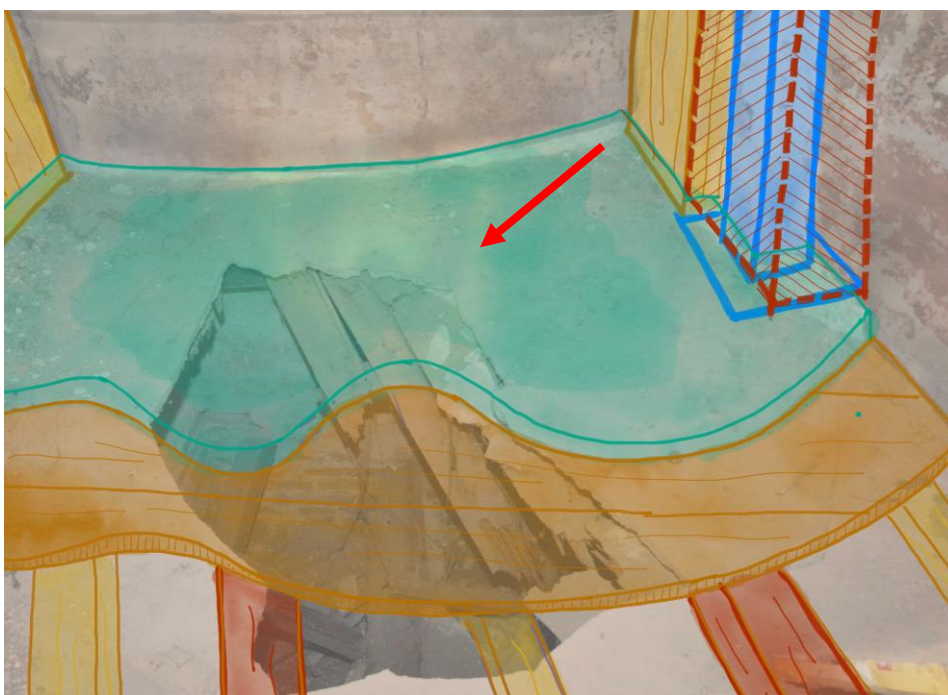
Intervento sui solai dei palchetti (vista estradosso): Raddoppio orditura dei travetti, nuovo tavolato ligneo e cappa collaborante a basso spessore (in verde)
